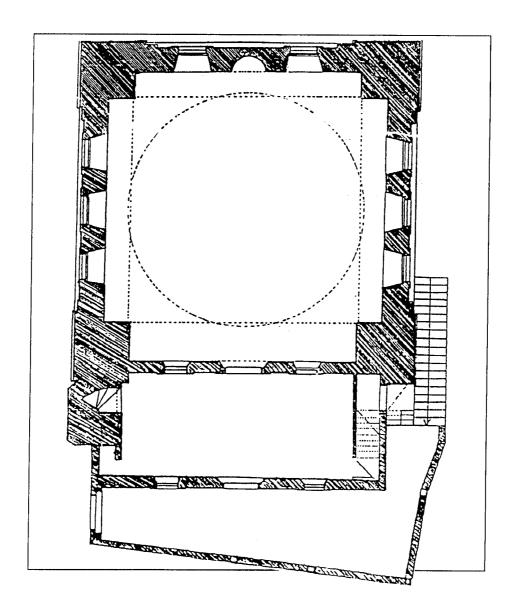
ه مكرر) مسقط أفقي لتربة حاجي سلطان في بورصة (عن : Wilde) .
